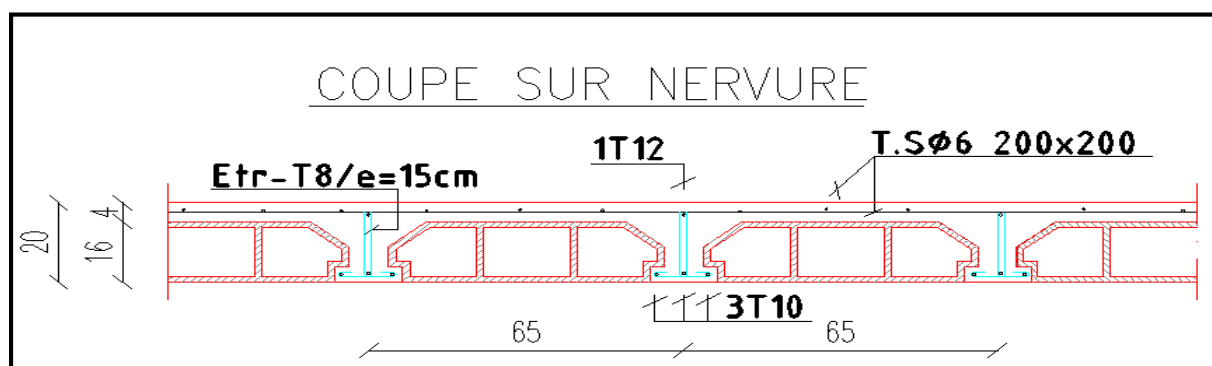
Disposition constructive des armatures dans la poutrelle en appuis de rive et appuis intermédiaires et sur travée (terrasse).
